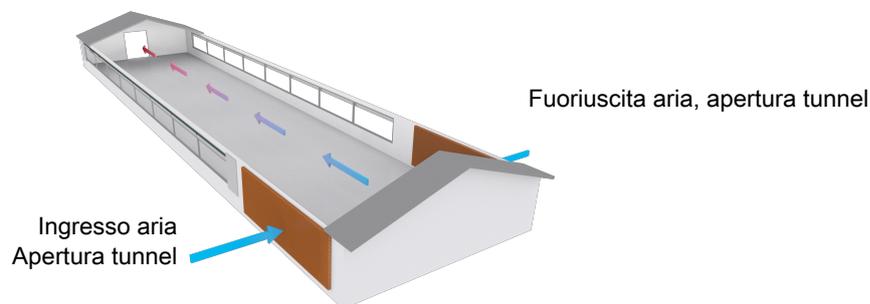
Esempio di capannone con ventilazione naturale unita alla ventilazione tunnel, Ventilazione tunnel
